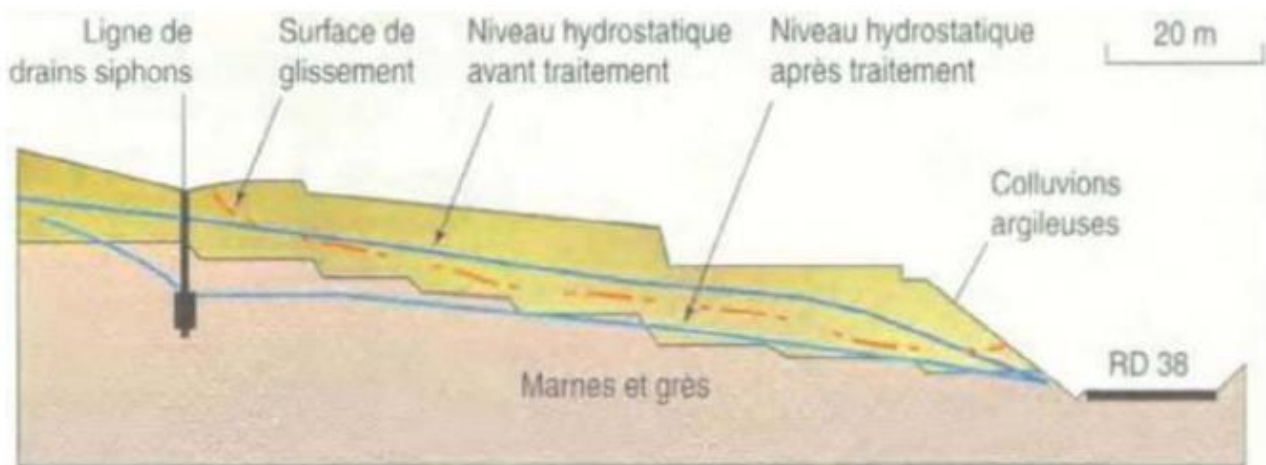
Stabilisation par drains verticaux du glissement.
